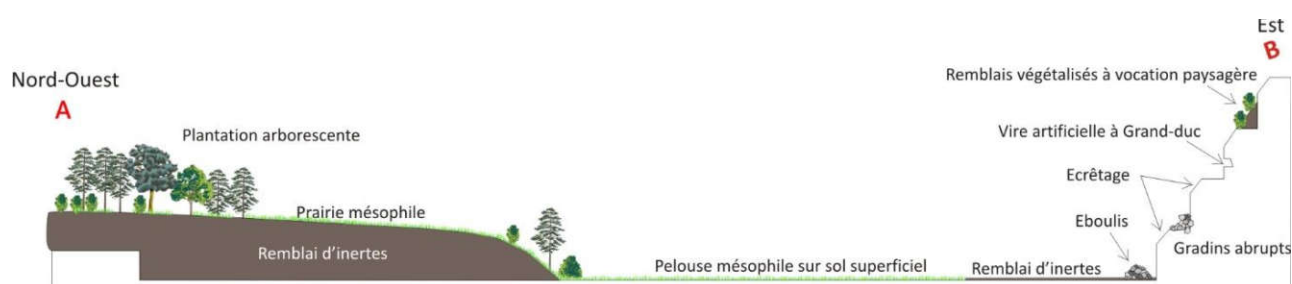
Coupe Nord-Ouest/ Est de la carrière
